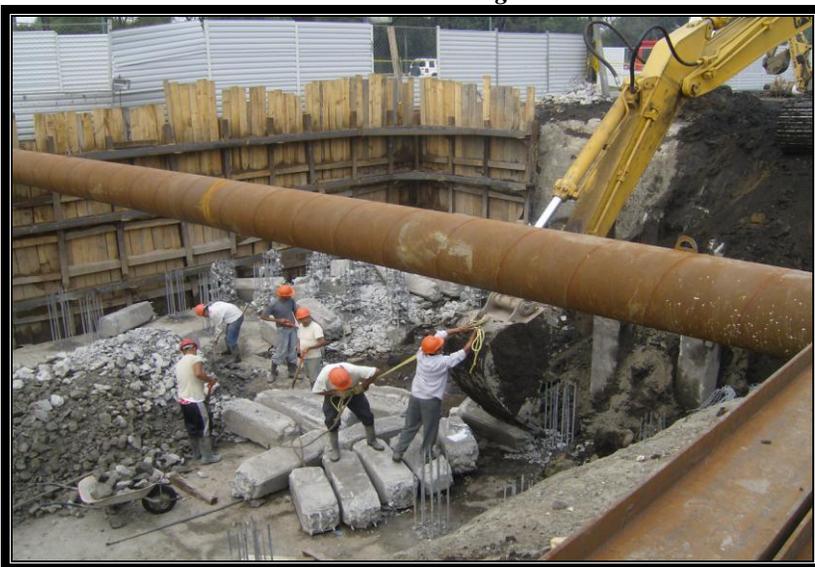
Proceso de retiro de cabezas de pilotes y fragmentos de concreto.
